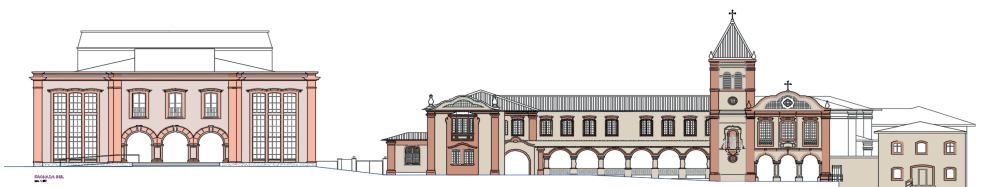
Fachadas voltadas para a rua Monte Alegre. Fonte: Acervo FUNDASP.
